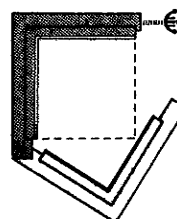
Principe de décoffrage du poteau « DEMI-COQUILLE ».
